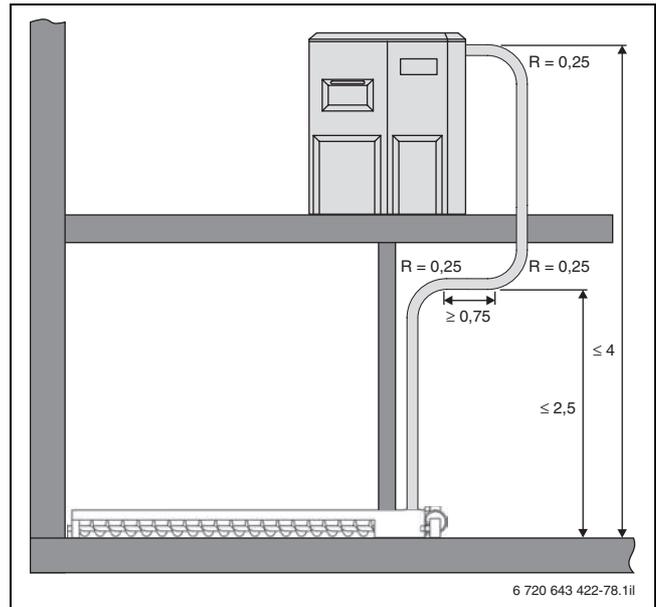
Schlauchverlegung Schnecke (Maße in m)
